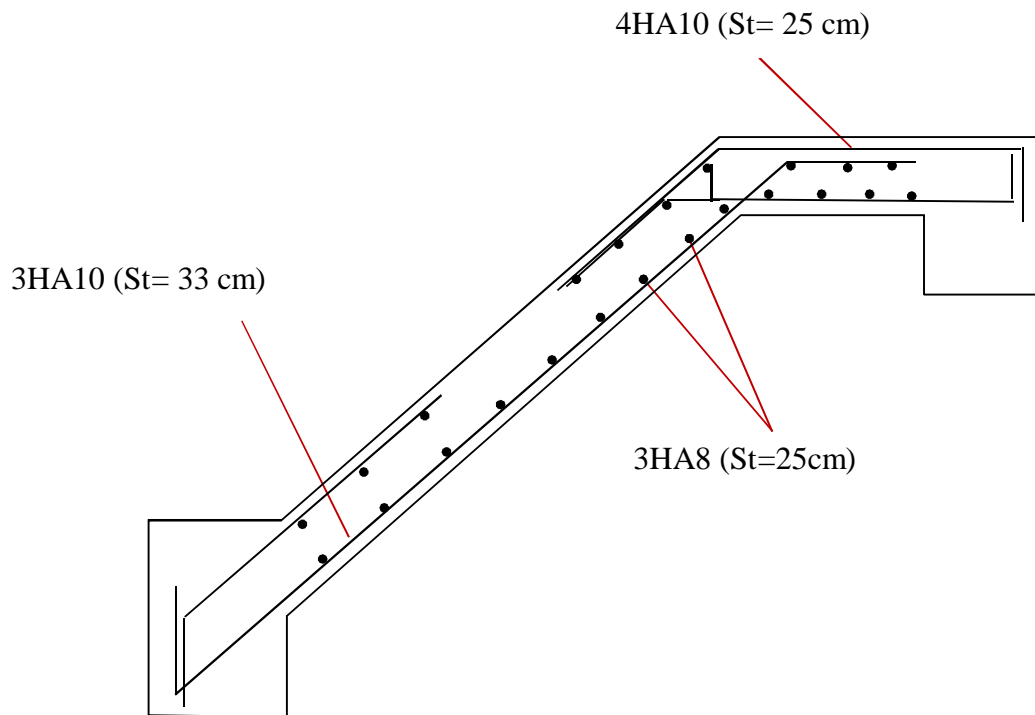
Schéma de ferrailage de l'escalier type 1(RDC)
